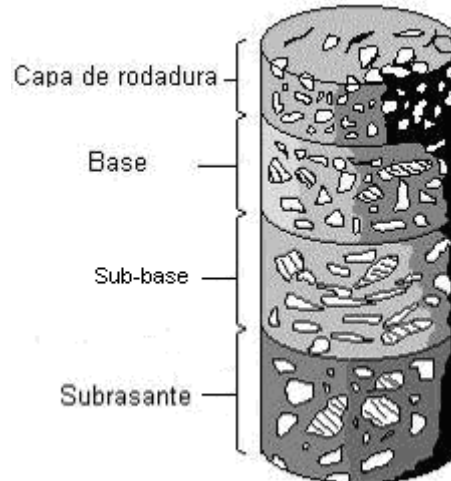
Muestra típica de extracción de núcleo de pavimento.
